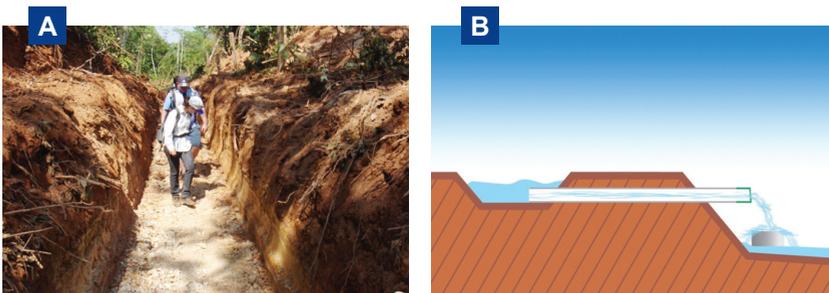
Sistema de abastecimento de água por canaleta a céu aberto (A); Detalhe de corte transversal da canaleta e tubo para abastecimento do viveiro (B). Foto: Fabrício P. Rezende; Ilustração: Jefferson Christofolletti.
